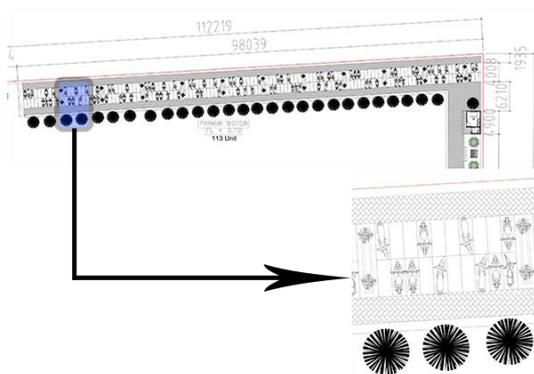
Sirkulasi pengunjung dengan mobil motor
